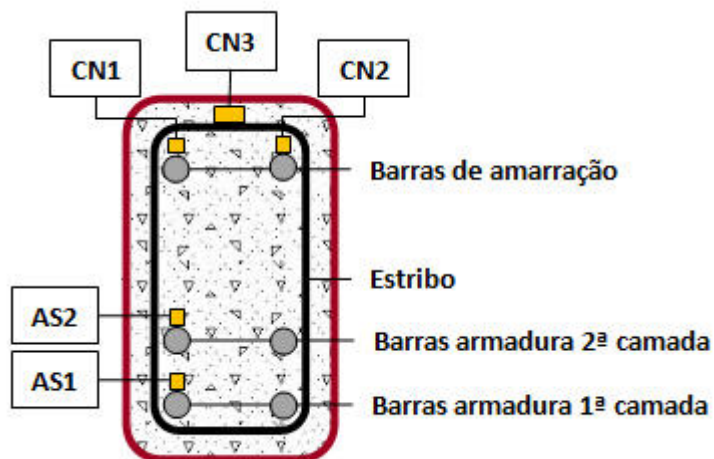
Ensaio de flexão: designação dos extensômetros na armadura
